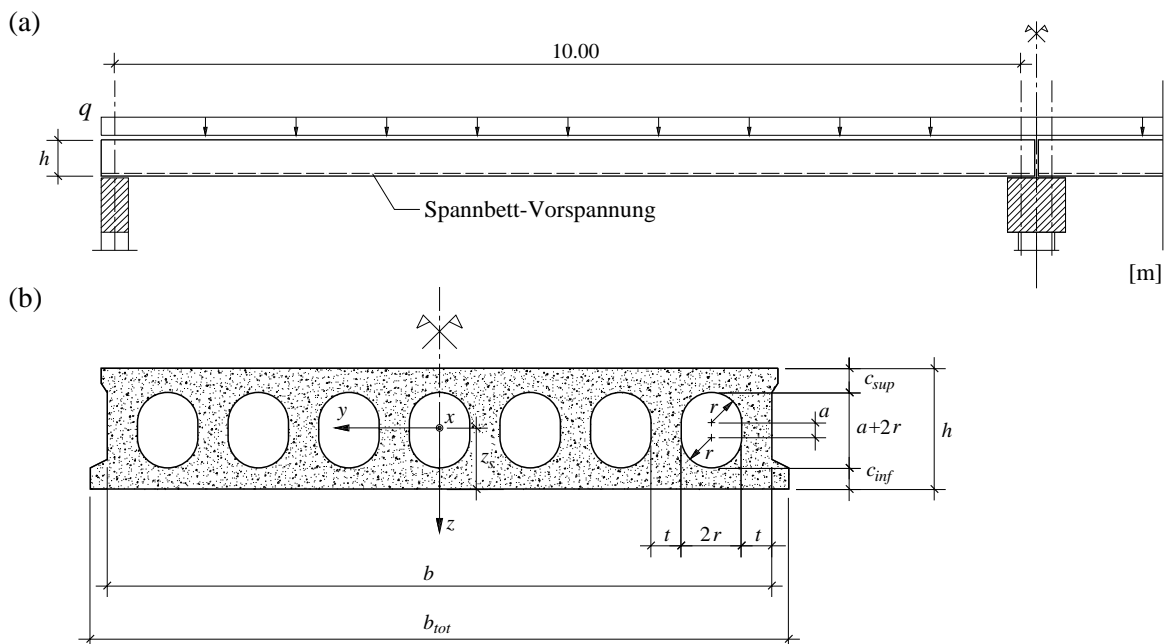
(a) Geometrie und Belastung; (b) Querschnittsabmessungen der Plattenelemente.
